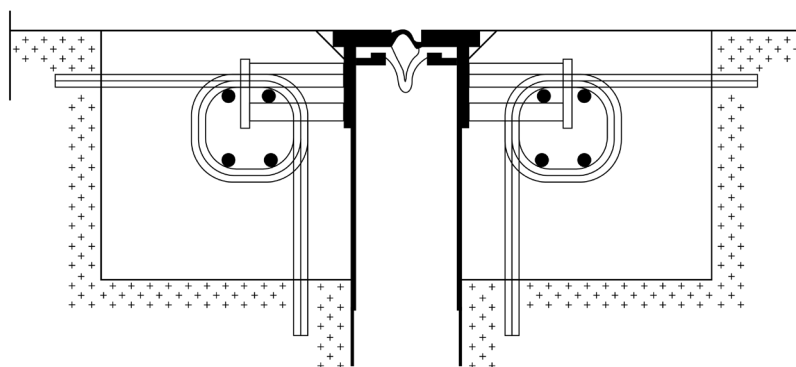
Joint ancré dans un bloc de béton, jusqu'à la surface de la chaussée
